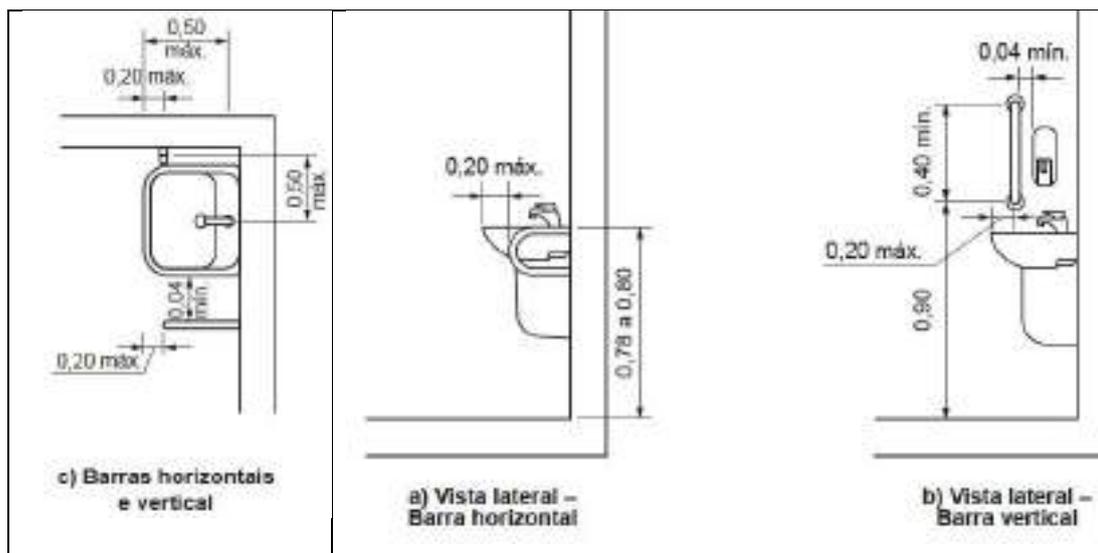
Detalhe da NBR 9050 – Barra de apoio no lavatório – vista superior e vistas laterais
